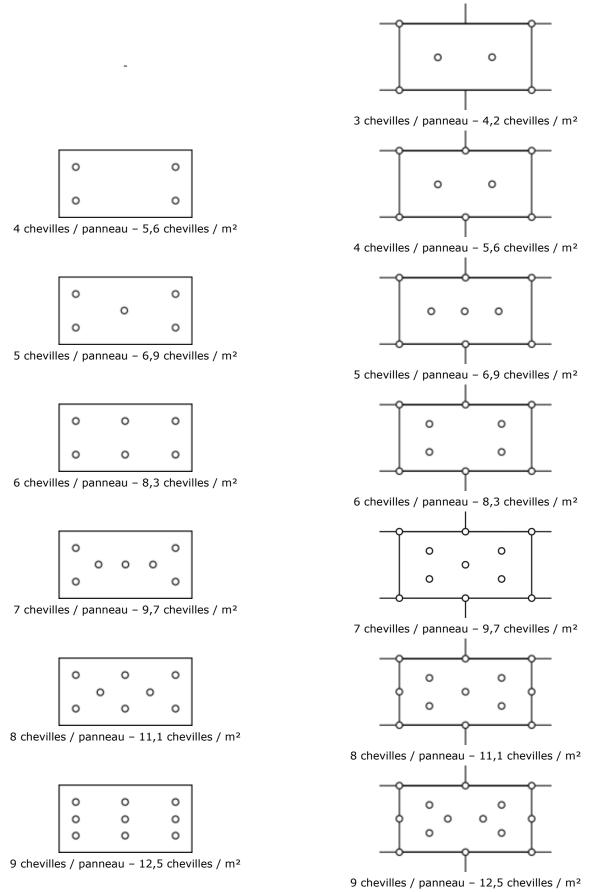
Exemples de plans de chevillage pour des panneaux de 1200 imes 600 mm
